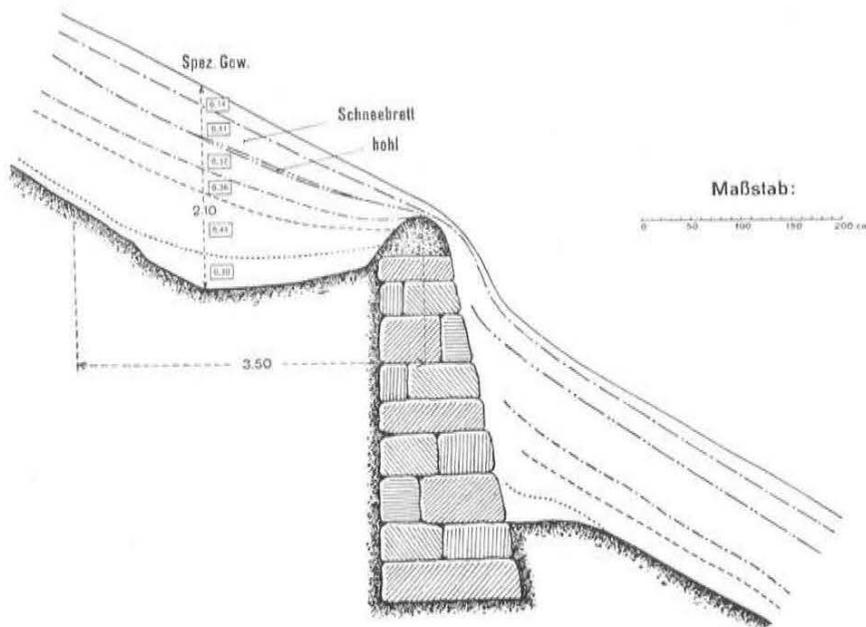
Eingewehrte Mauerterrasse. Alpetta, 2230 m ü. M.
